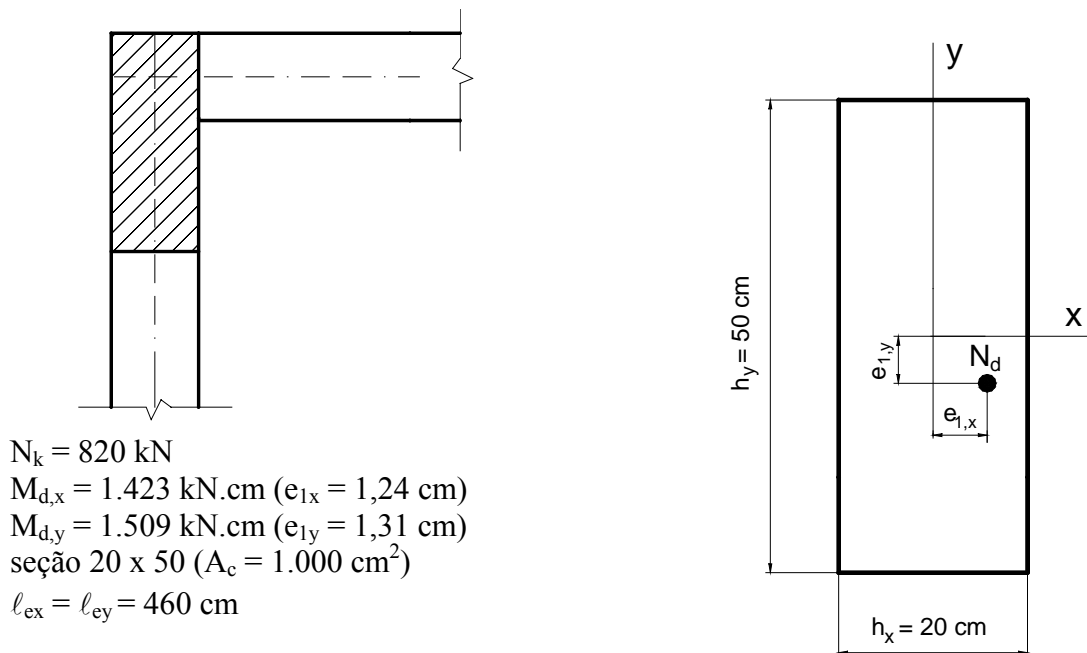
Arranjo estrutural do pilar na planta de fôrma e dimensões da seção.
